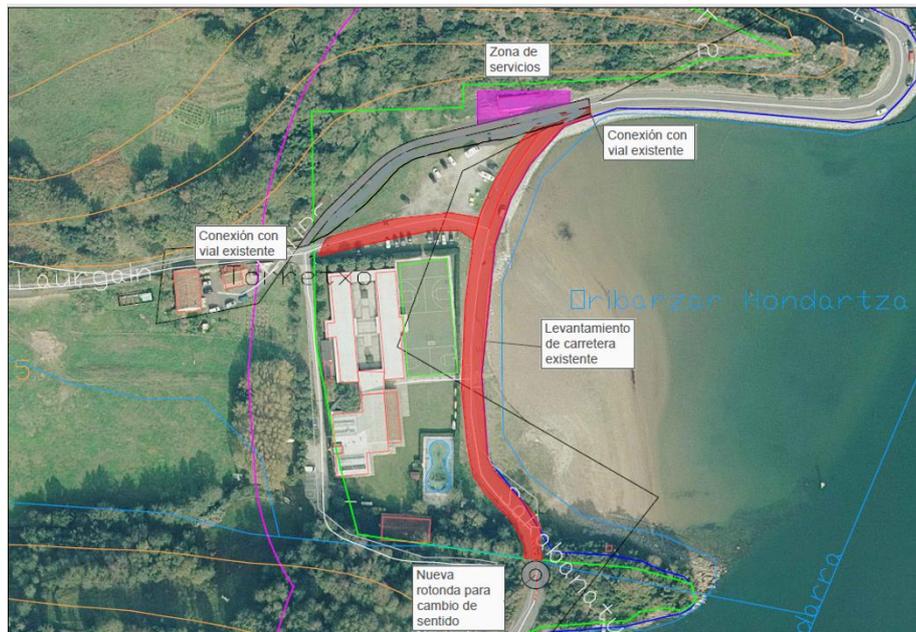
Trazado propuesto para la Alternativa 3. Fuente: elaboración propia.
